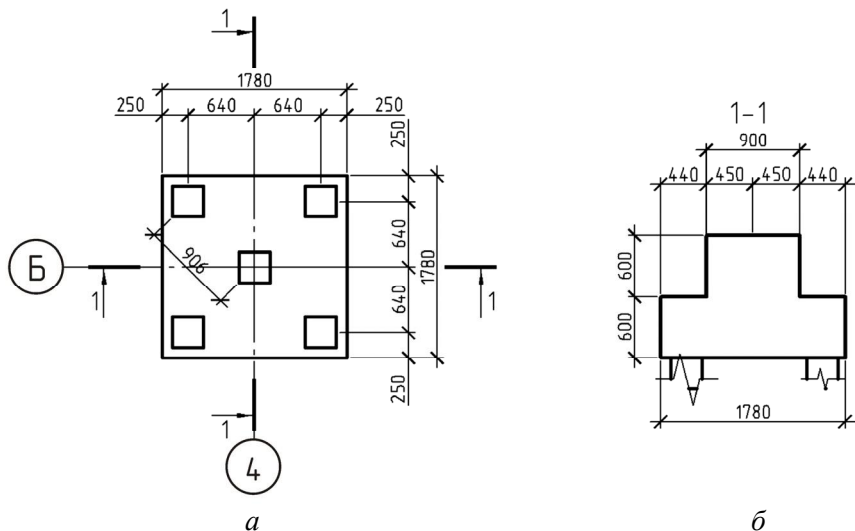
Схема расположения свай (а) и поперечный разрез ростверка (б)
